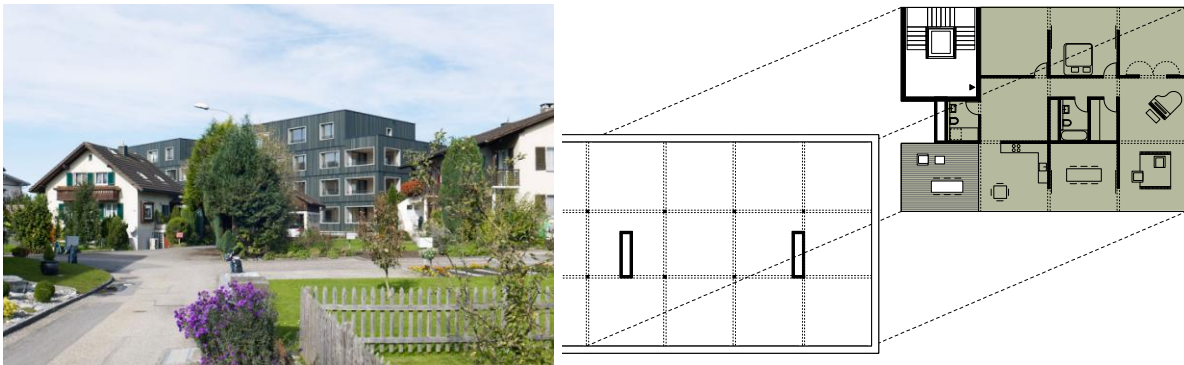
Pilotprojekt Swisswoodhouse in Nebikon/LU, Bild und Grundriss / Bauart Architekten und Planer AG
